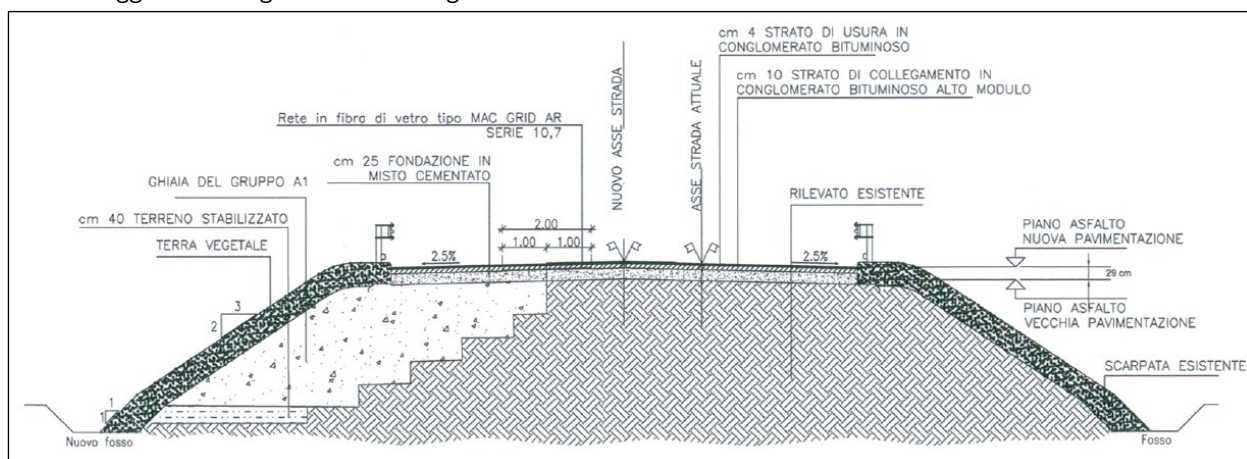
Sezione tipo tratta dall'elaborato as.built (rif. D.07.04) agli atti di FVG Strade.
